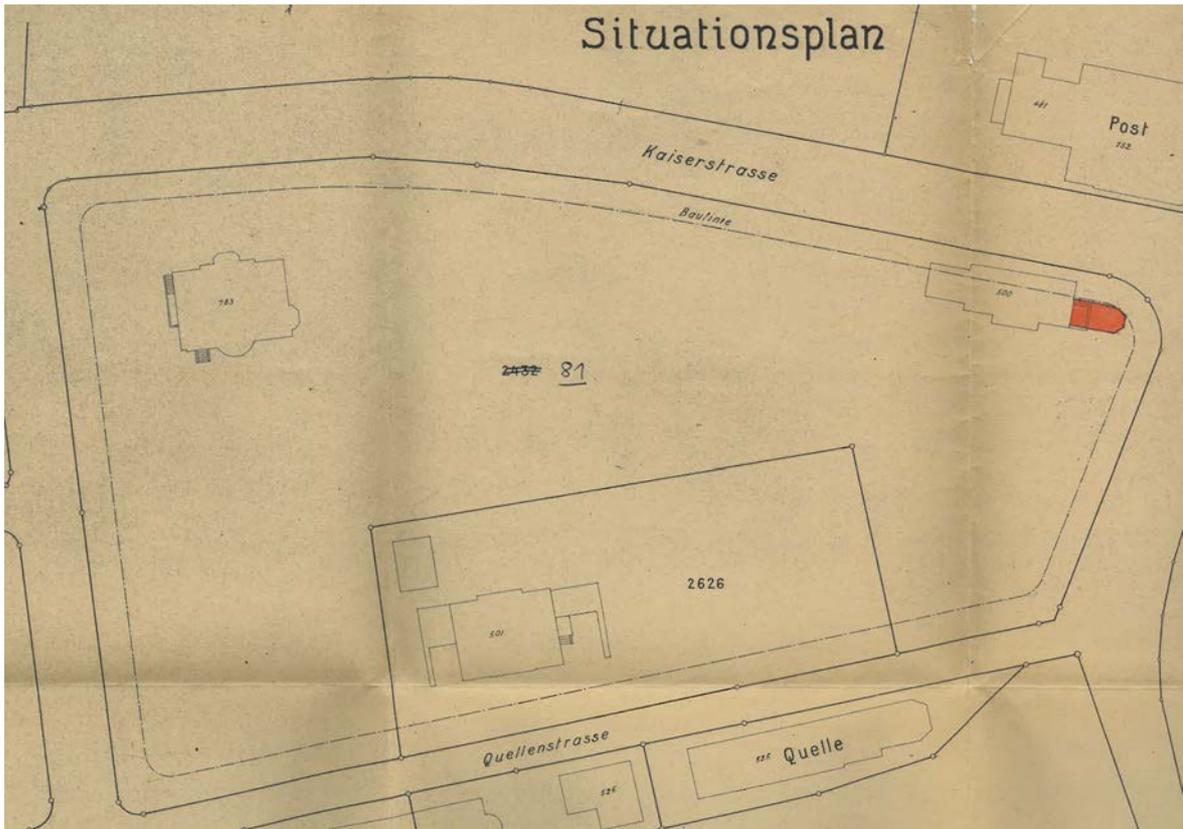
Situationsplan von 1935 aus der Baueingabe für das Treibhaus. Quelle: Stadtbauamt Baugesuchsakten.
